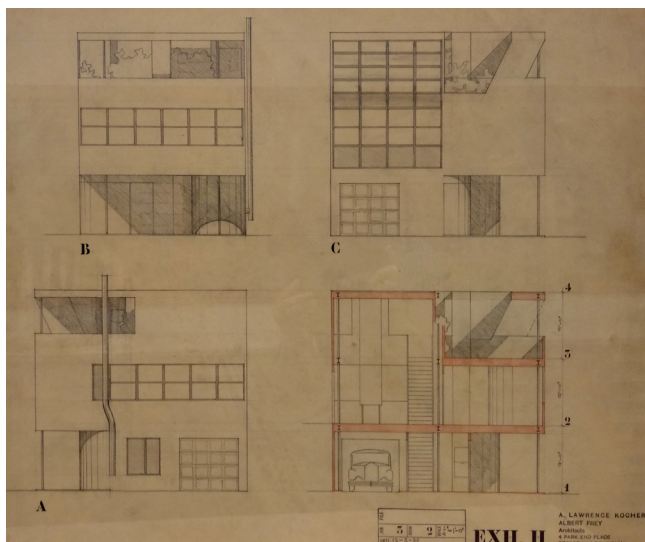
Aluminaire House. Plano de montaje de la estructura. John D. Rockefeller Jr. Library.
